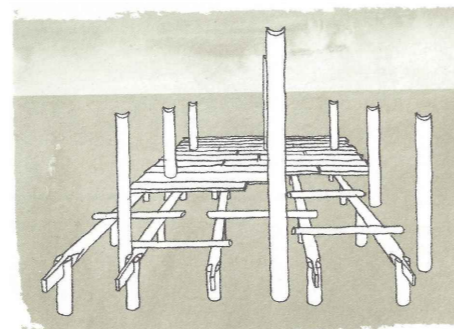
| Construção de uma palafita - Colocação do pavimento.
